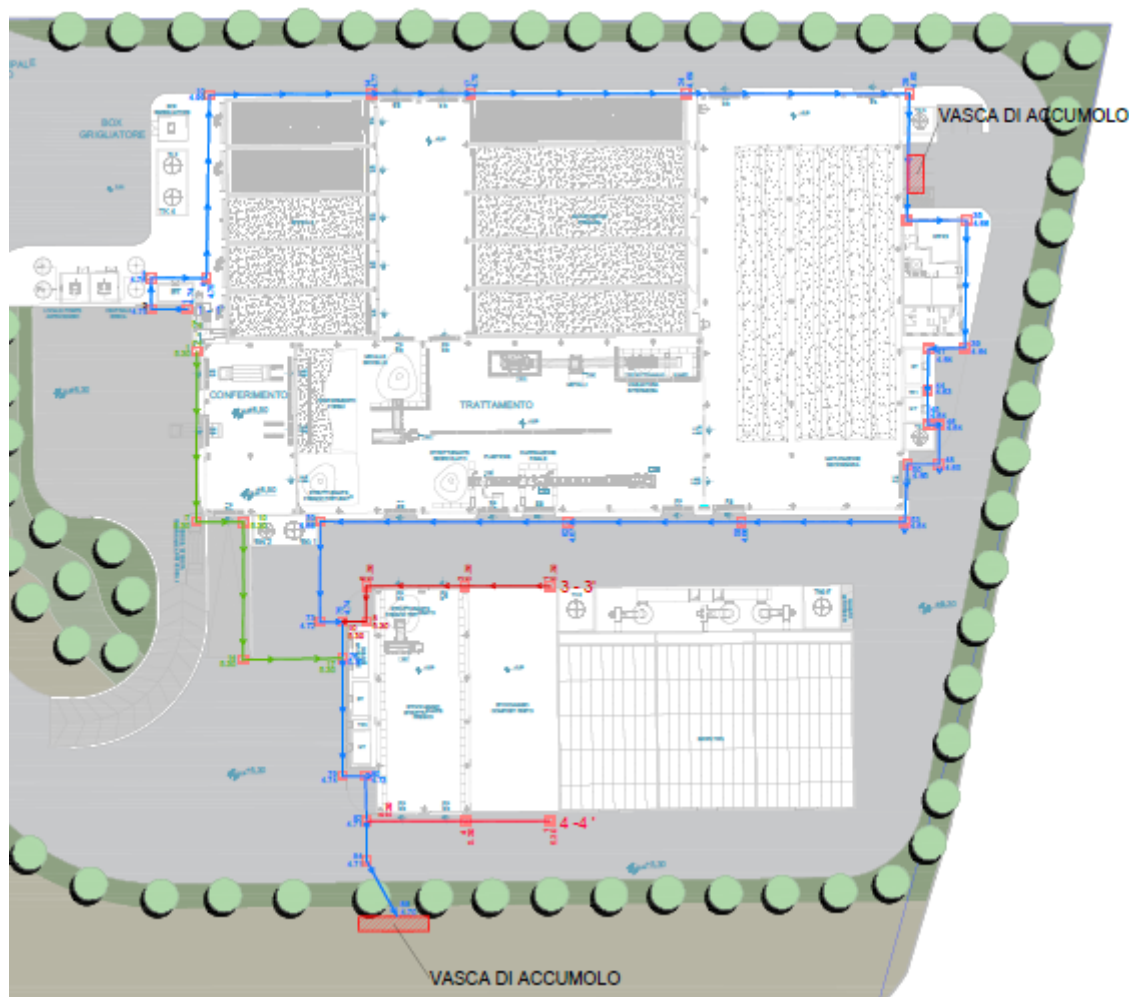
PLANIMETRIA ACQUE METEORICHE DAI PIAZZALI
